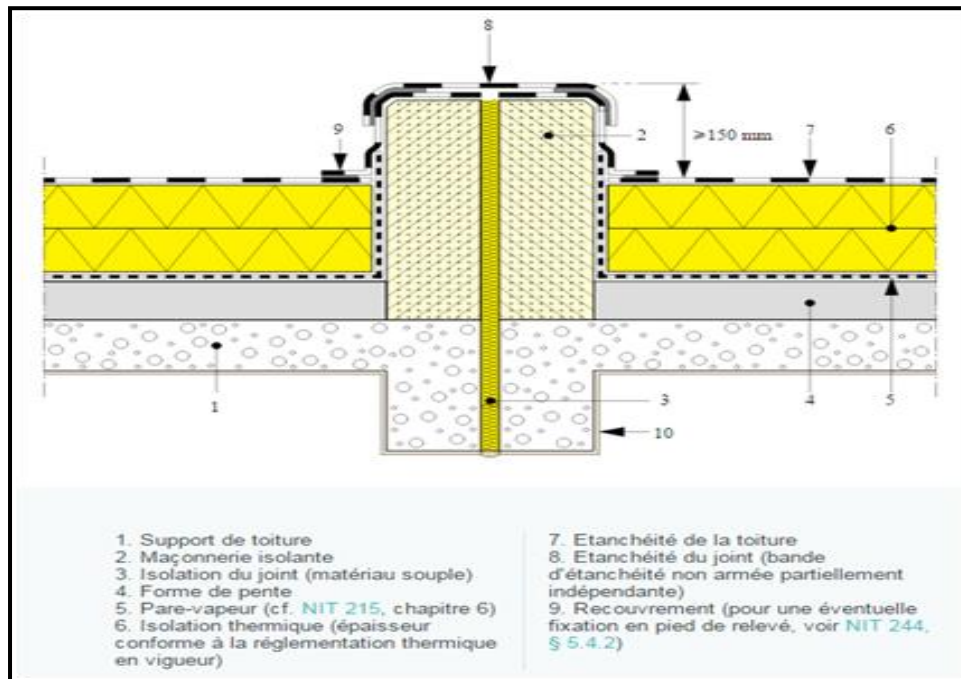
Etanchéité d'un joint de mouvement réalisée au moyen d'un matériau d'étanchéité souple.
